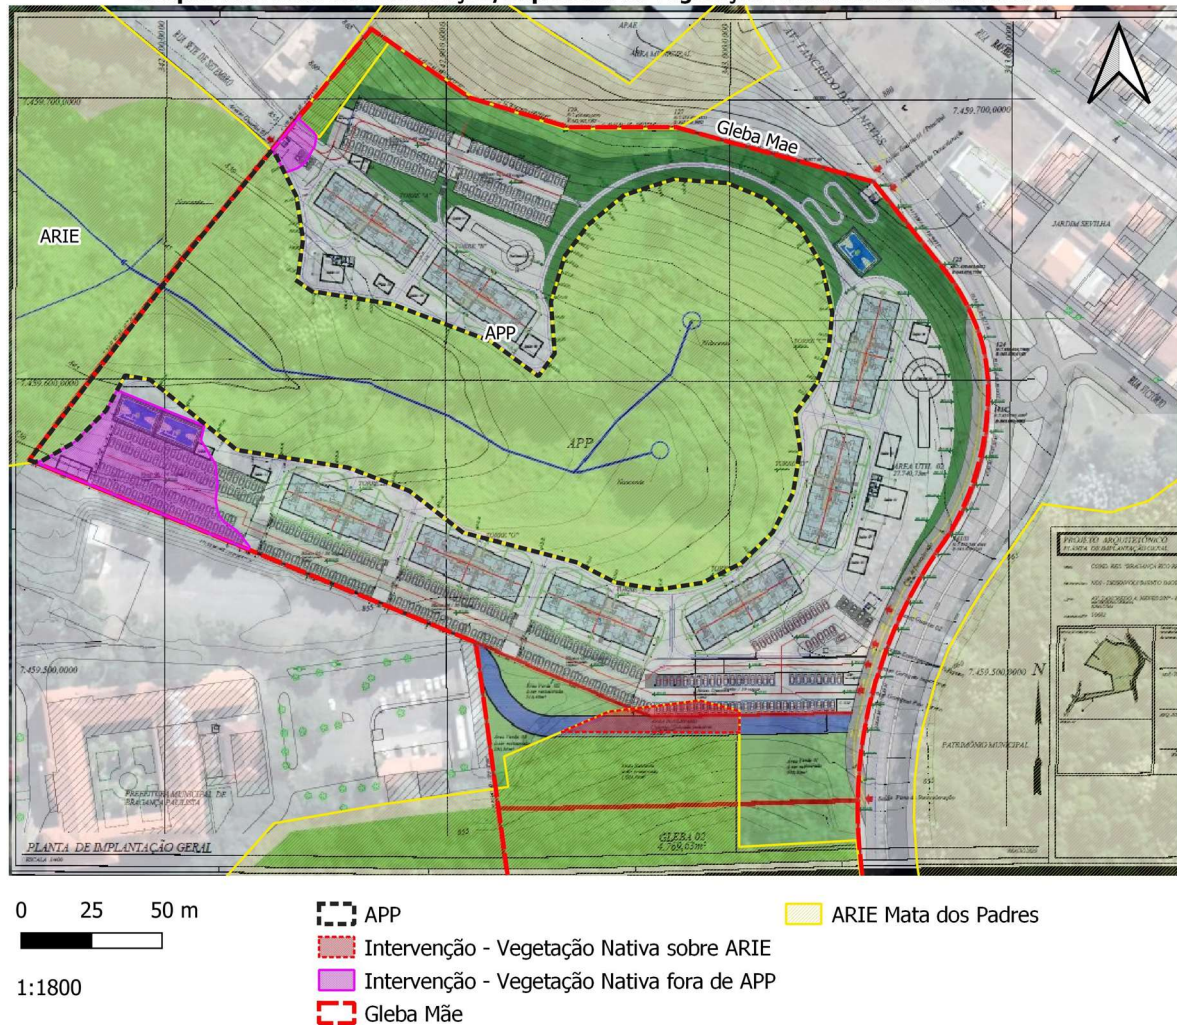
Croquis das Áreas de Intervenção/Supressão de Vegetação Nativa situada fora de APP em sobreposição ao Projeto Arquitetônico - Planta de Implantação Geral (Anexo 07) em conjunto com imagem do Google Earth.
